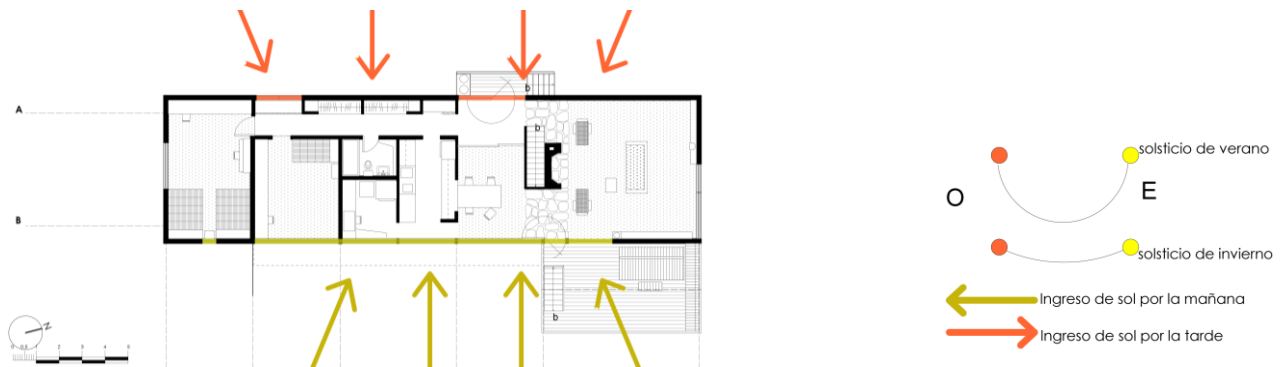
Ingreso de sol luz por las caras este y oeste del proyecto Planta baalta.
